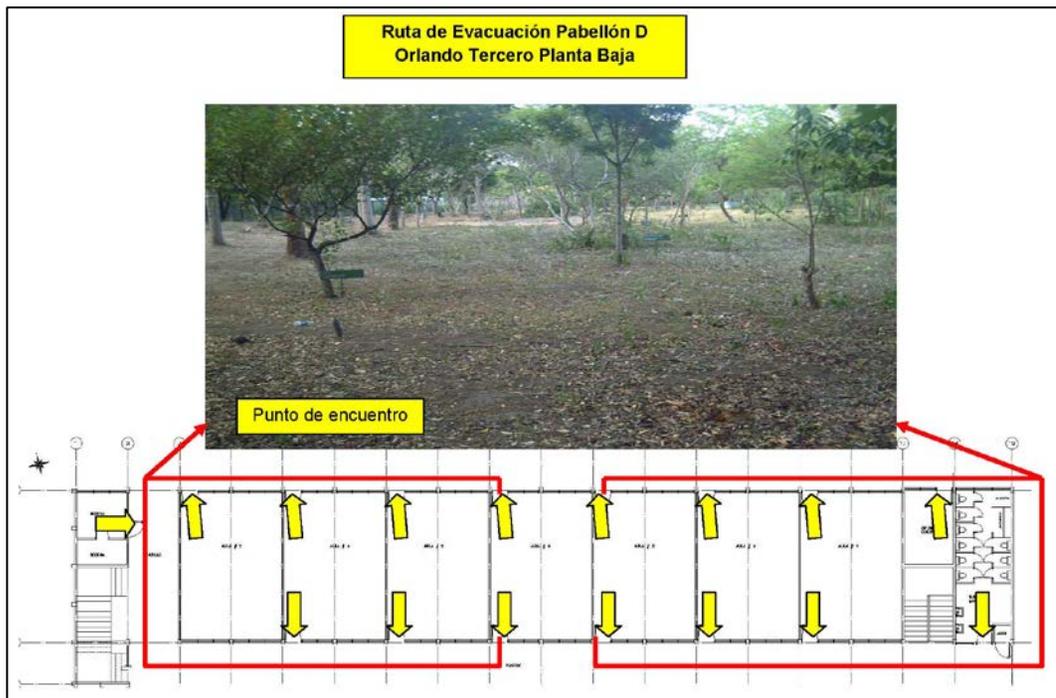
Ruta de evacuación del pabellón “D” (planta baja)
